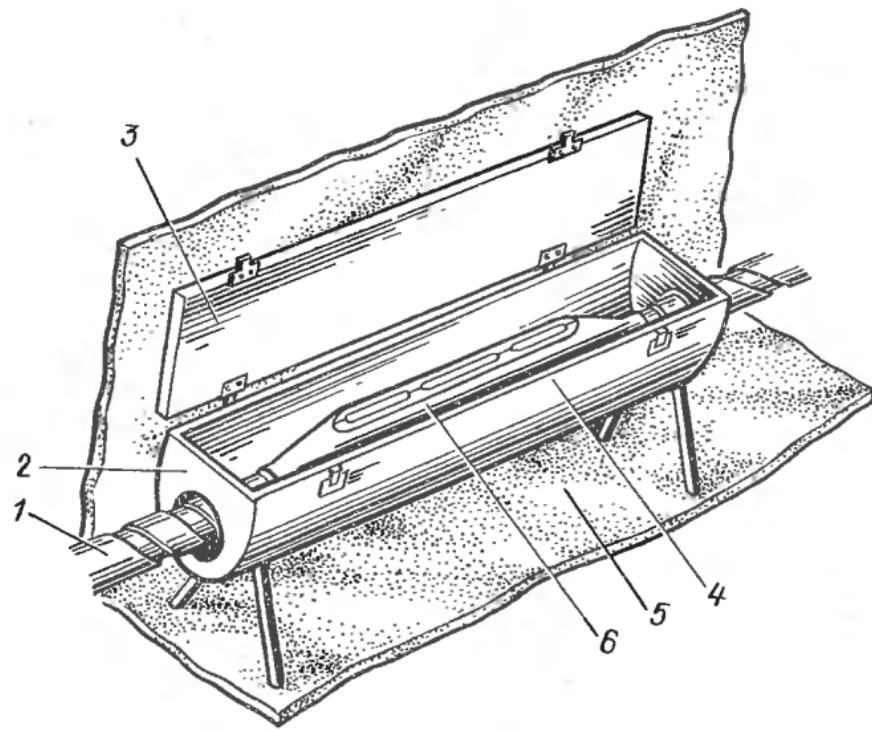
Химический обогреватель в металлическом кожухе для эпоксидных соединительных муфт:
